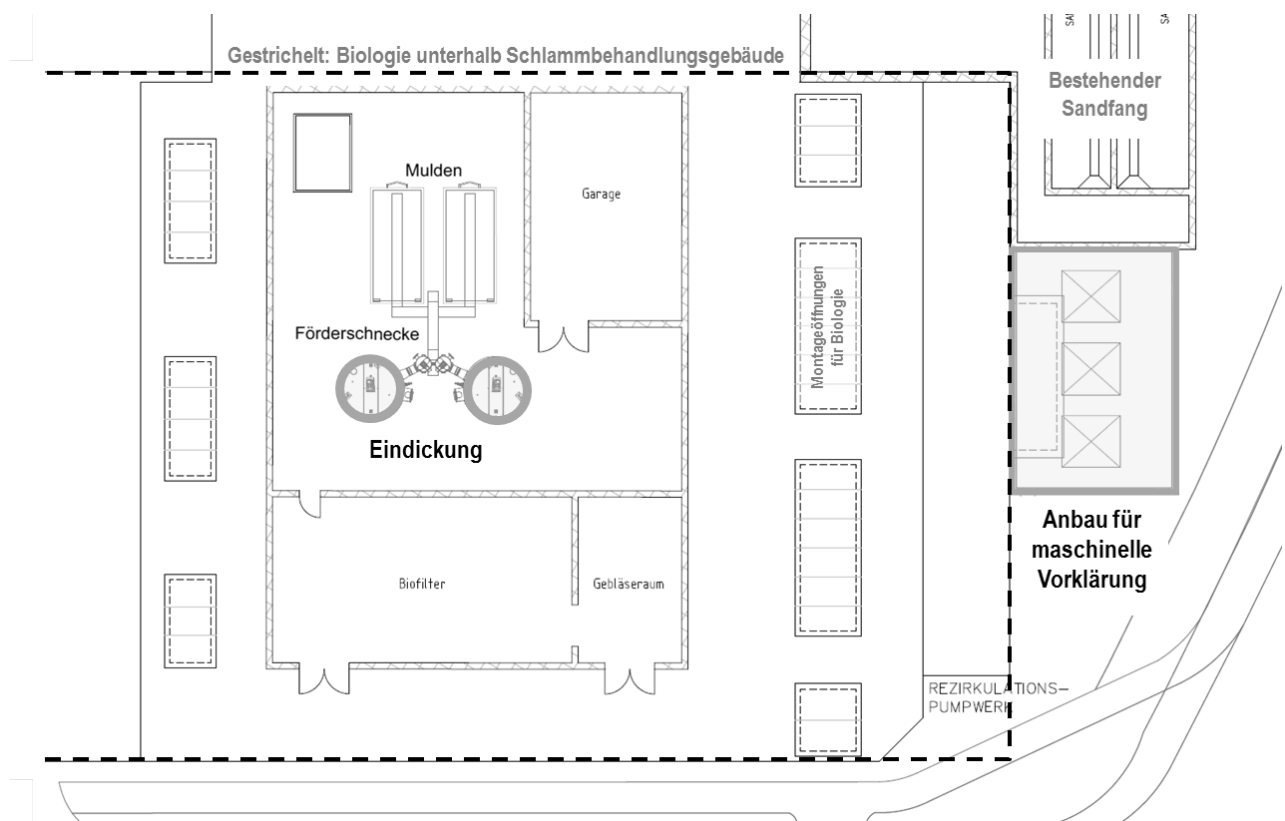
Bestehendes Schlammbehandlungsgebäude mit geplanter neuer Eindickung in EG (links). Situation maschinelle Vorklärung mit Einhausung (rechts).
